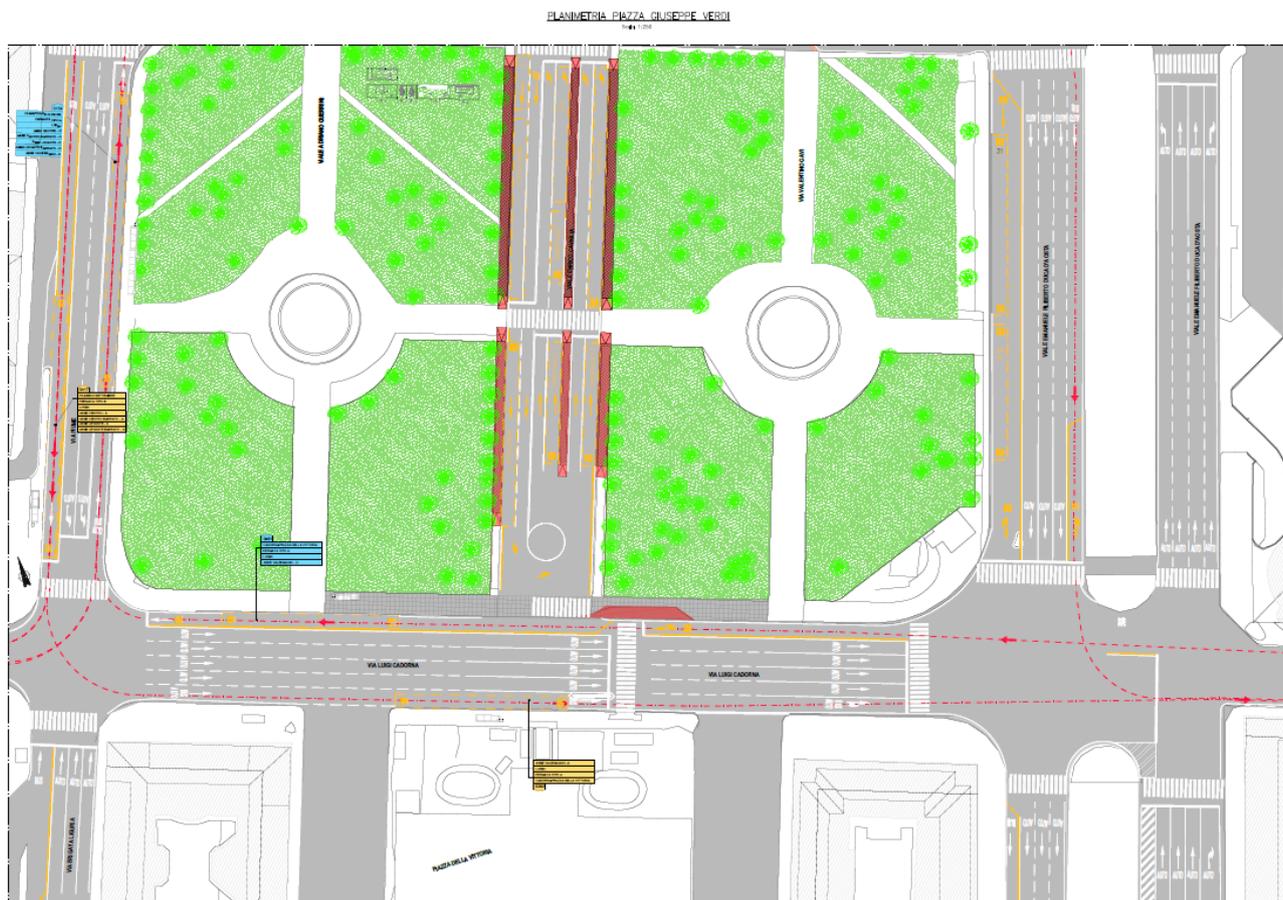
Esempio di Planimetria di dettaglio – Brignole: Via Cadorna – Viale Duca d’Aosta
